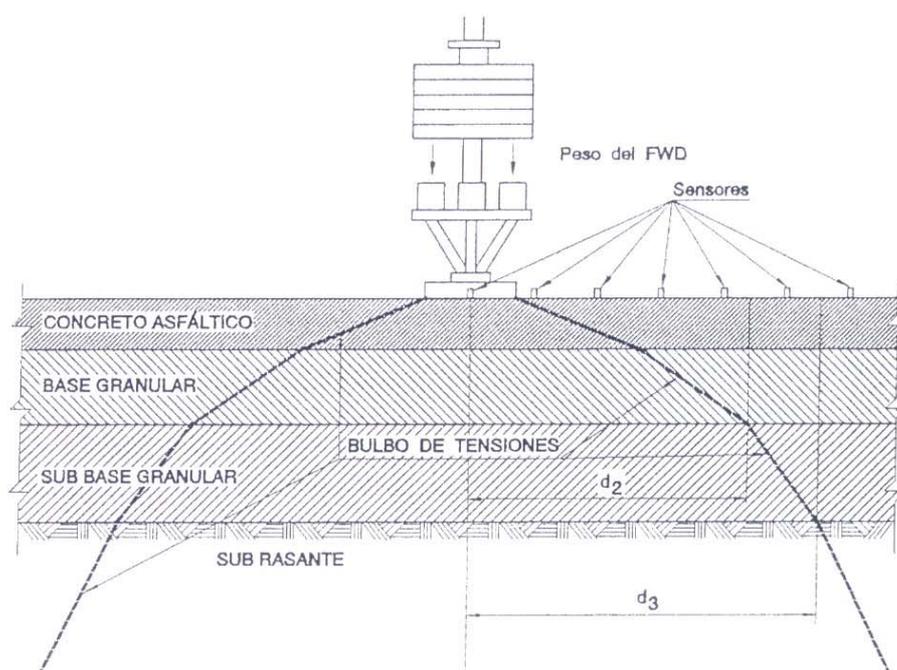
Esquema de la ubicación de los sensores y del bulbo de tensiones en un pavimento flexible
